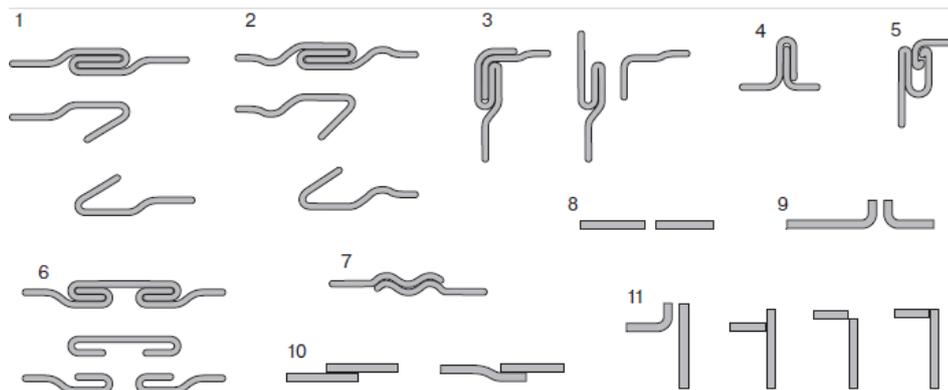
Разновидности фальцевых и сварных соединений металлических воздуховодов: 1 – на простом лежащем фальце; 2 – на фальце с использованием двойной отсечки; 3 – на угловом фальце; 4 – на поперечном фальце; 5 – на фальце с использованием защелки; 6 – соединительная планка; 7 – зиг; 8 – встык; 9 – встык с отбортовкой; 10 – внахлестку; 11 – угловые
